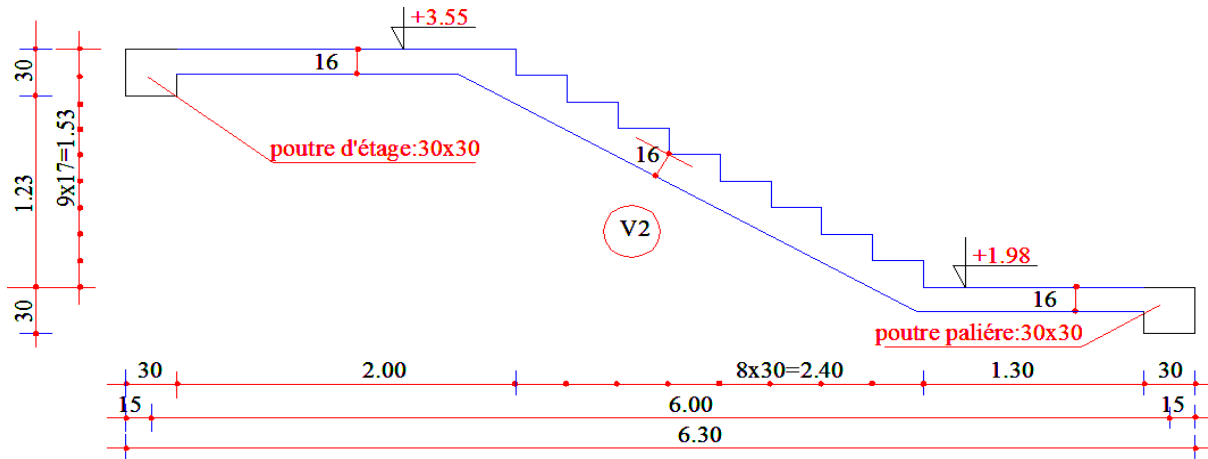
coupe d'escalier N°2 -volée-2- Niveau RDC et 16 étages
